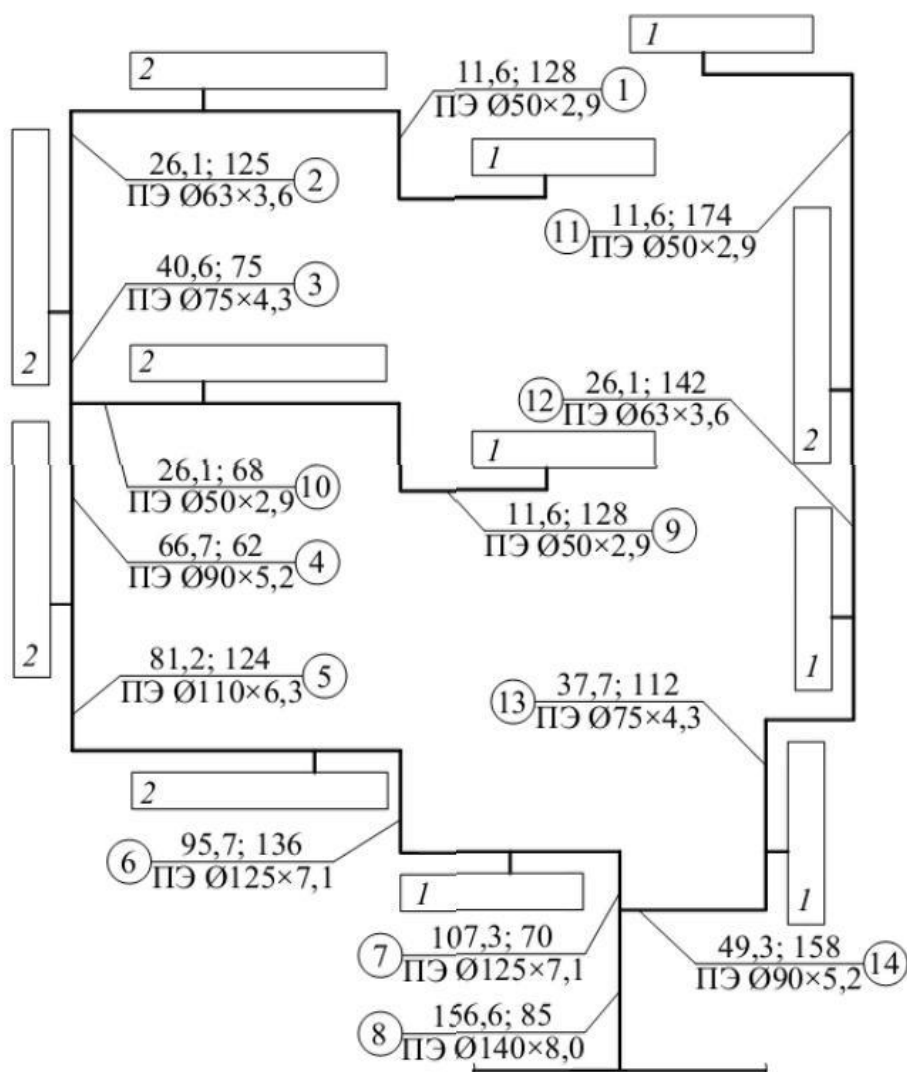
Расчетная схема квартальных газопроводов низкого давления
